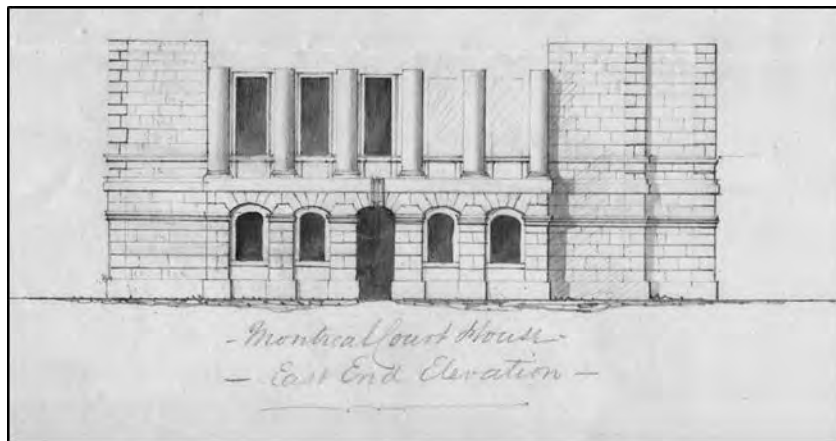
« Montreal Court House, East End Elevation », s,n., s.d., BAC, RG11 vol. 75, no. 12.
